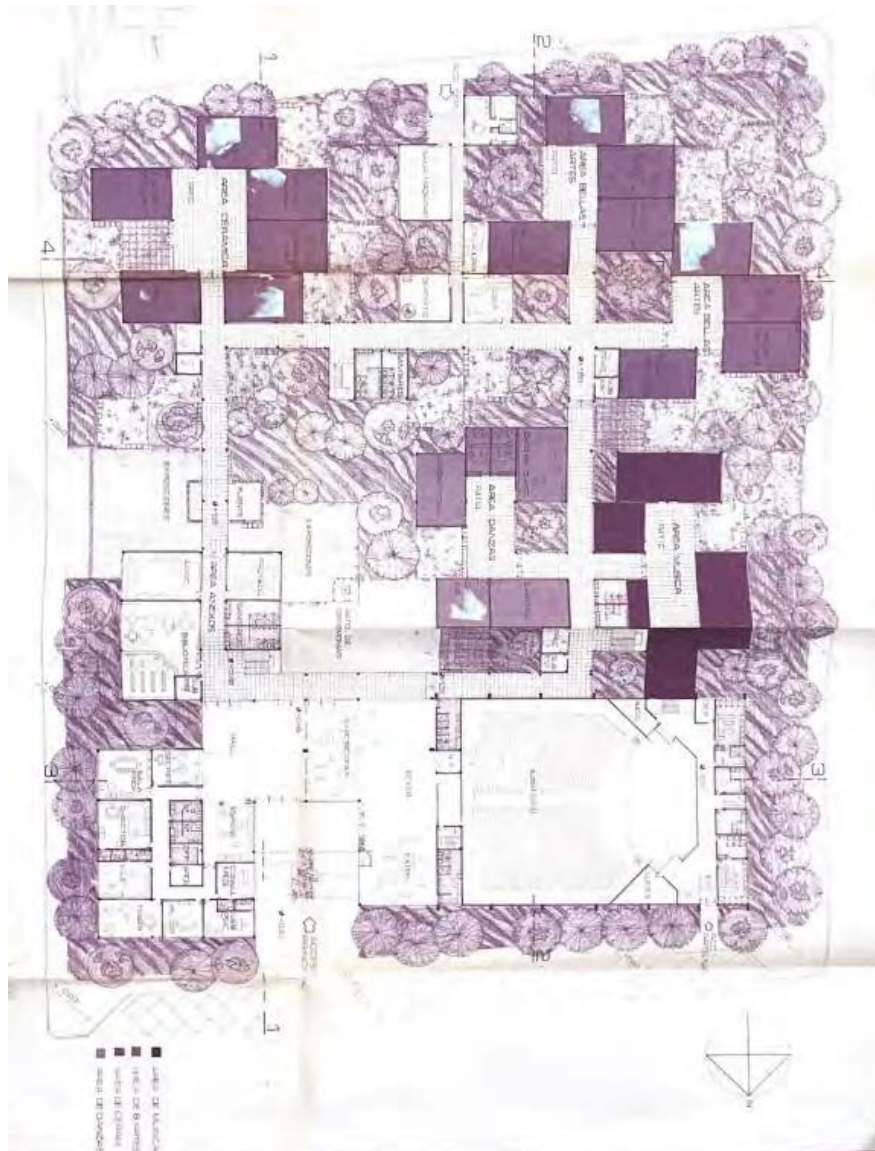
Planimetría del Proyecto Centro Universitario El Nevado
